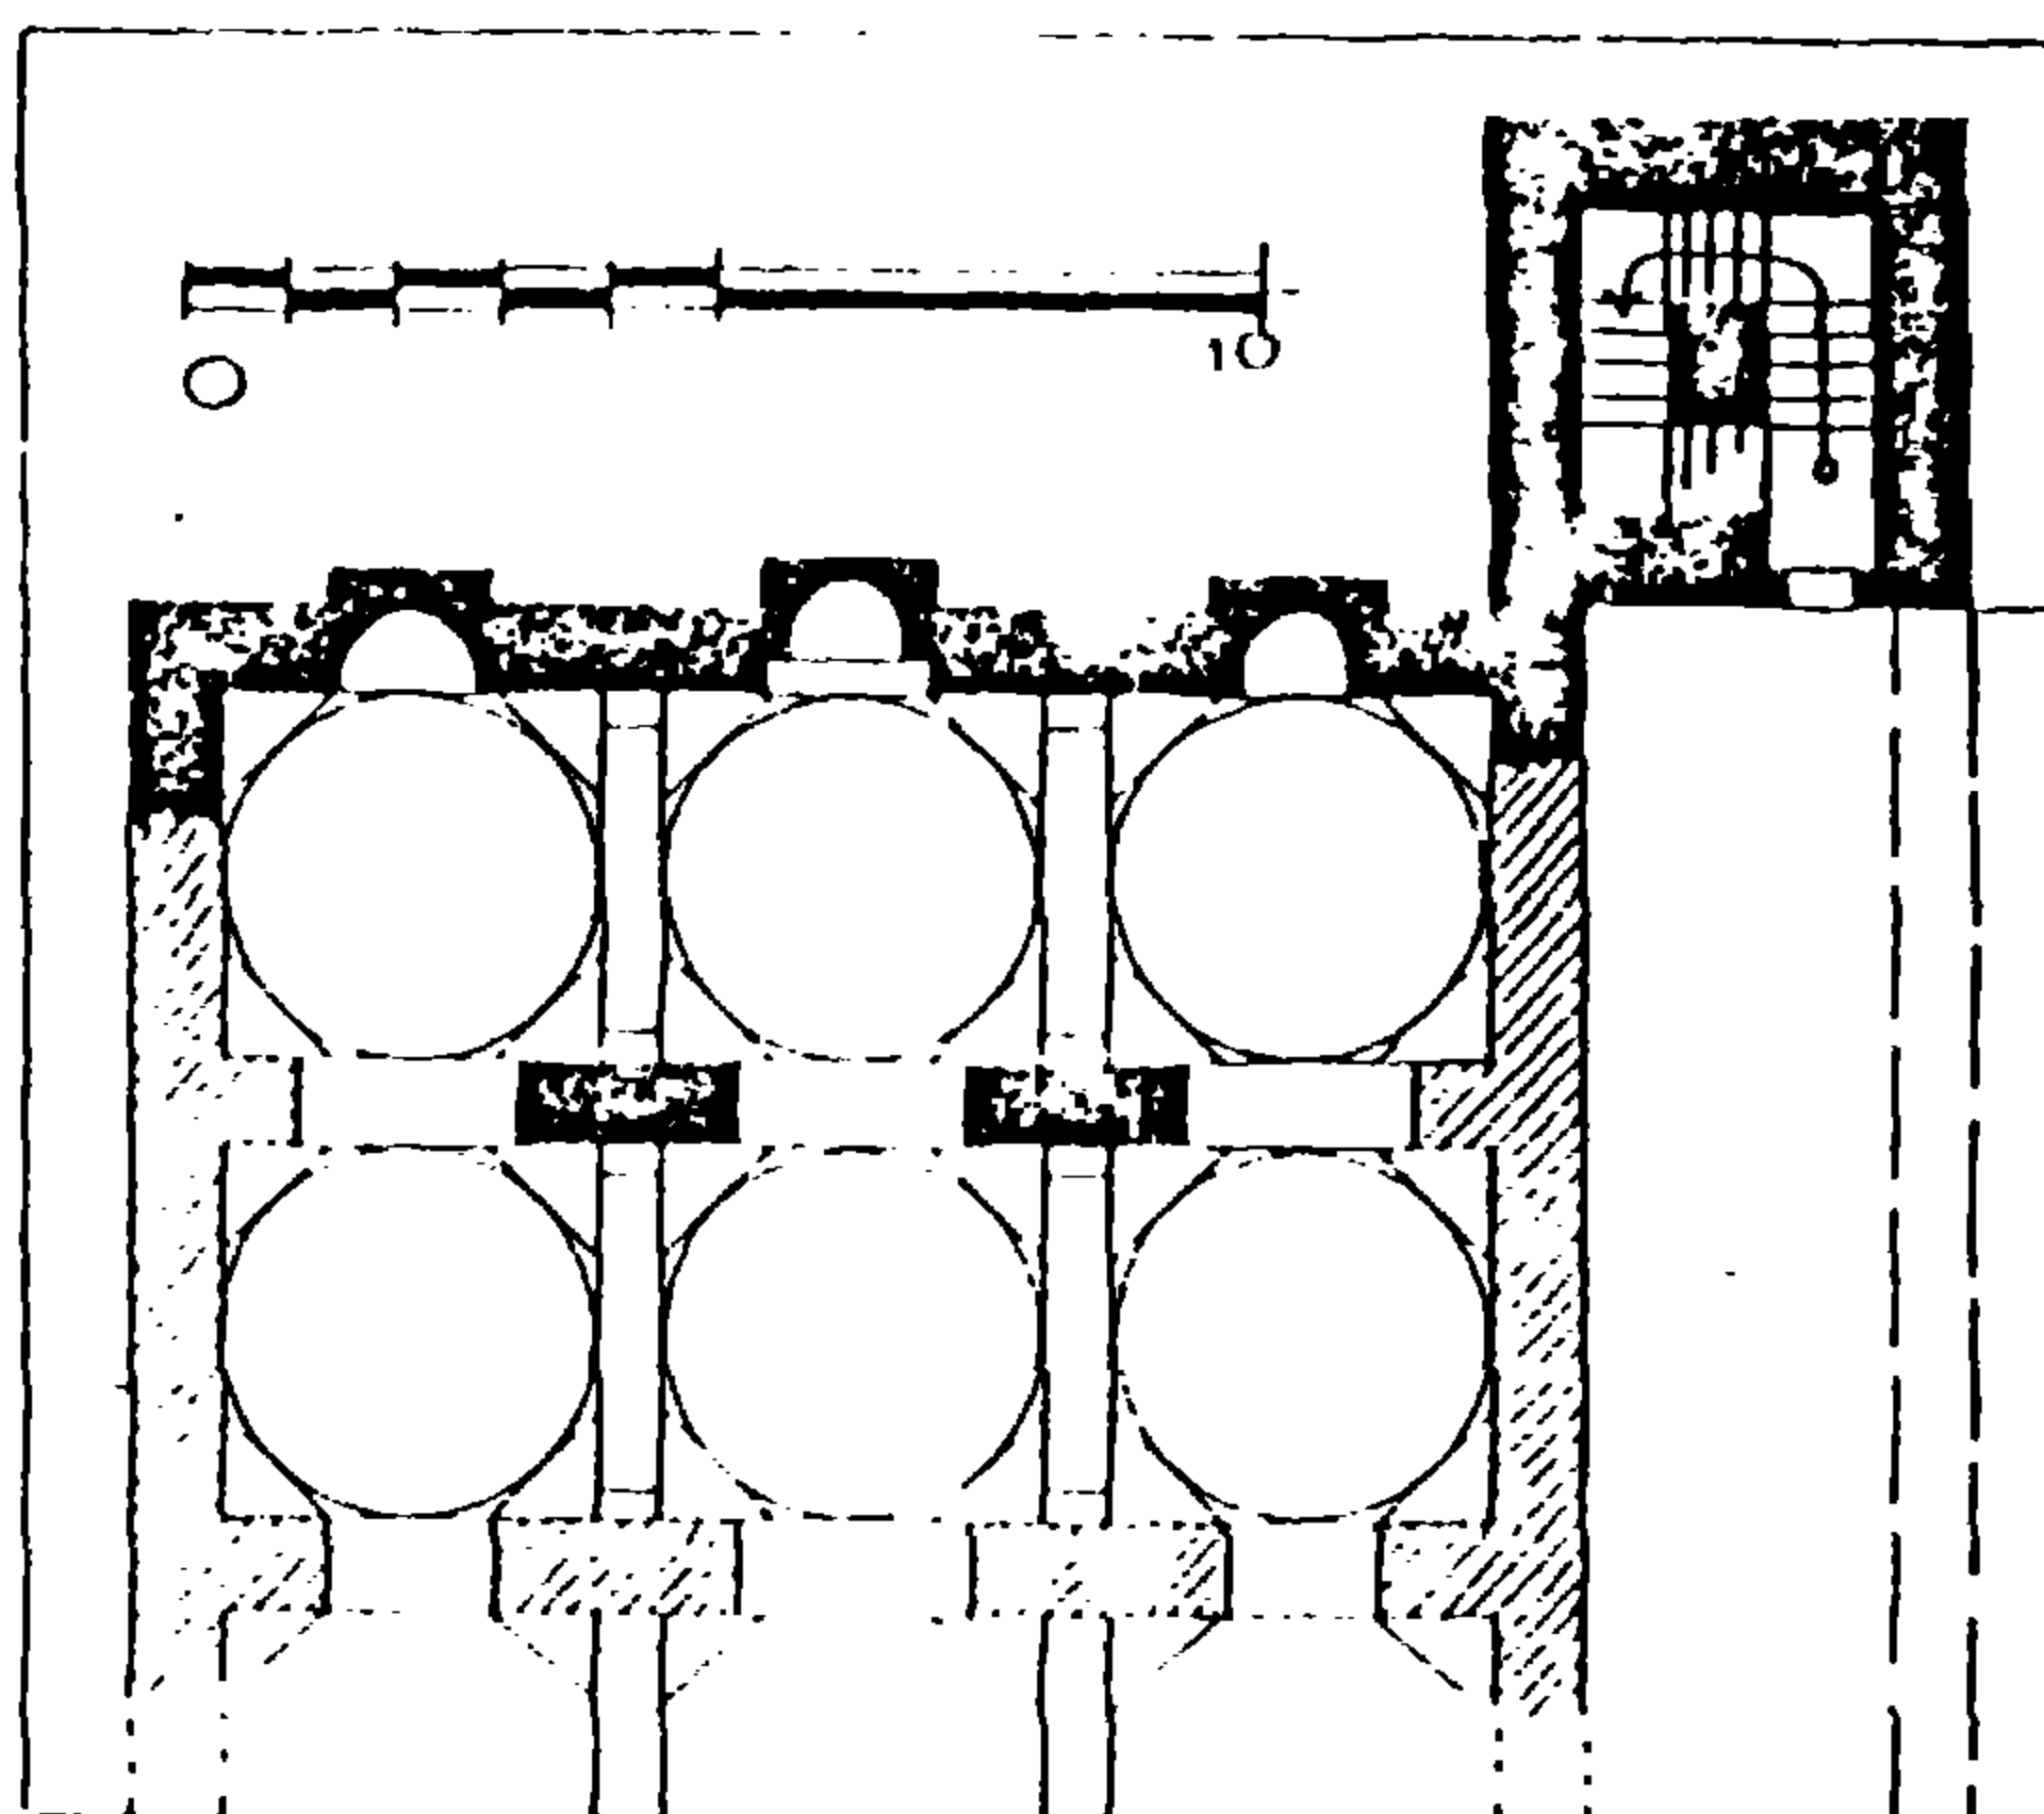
المسقط الأفقى لمشهد آل طباطبا
